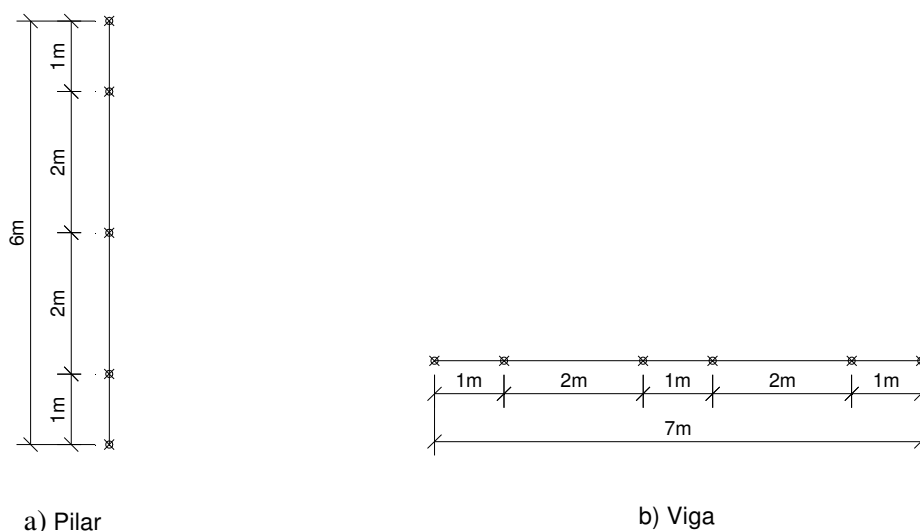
Malha de elementos finitos para pilares e vigas
